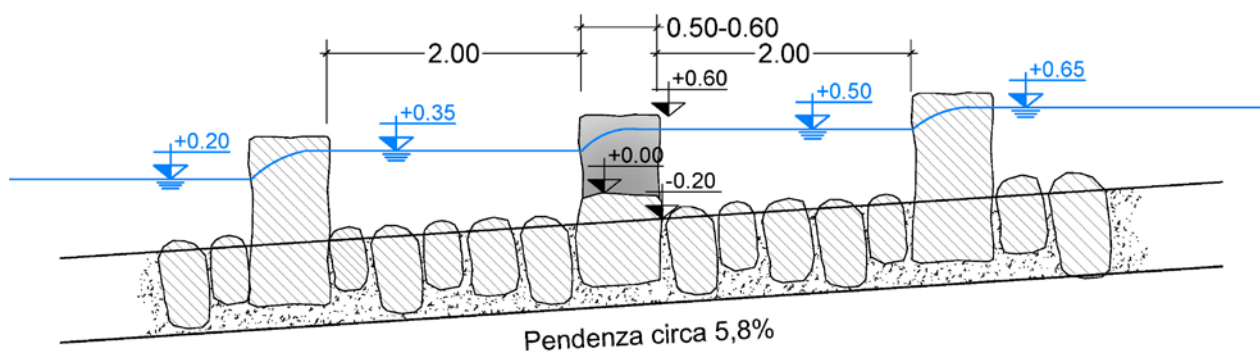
estratto della planimetria dell'opera in progetto presso la Discontinuità 4
